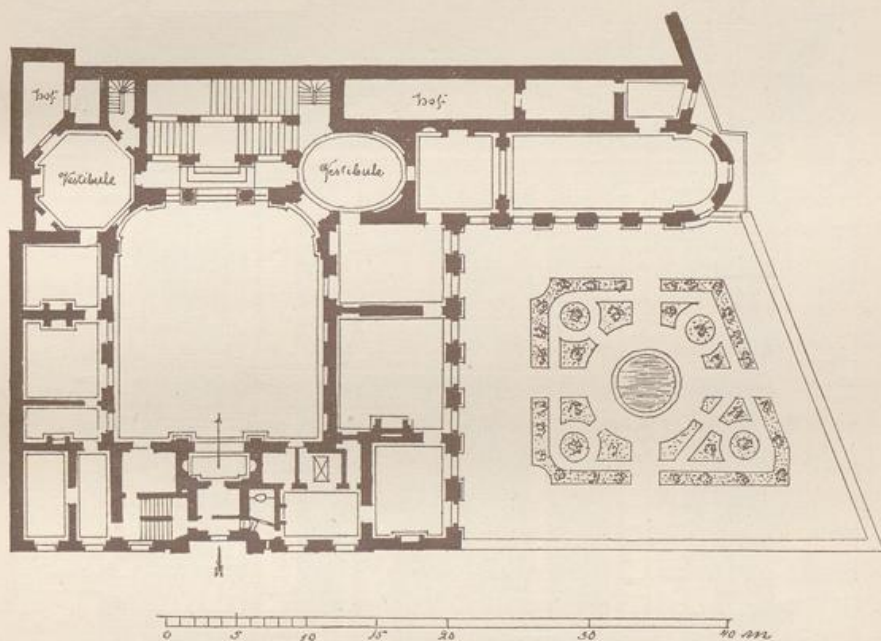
Hôtel Lambert. Grundriss I. Etage (n. Sauvageot).
